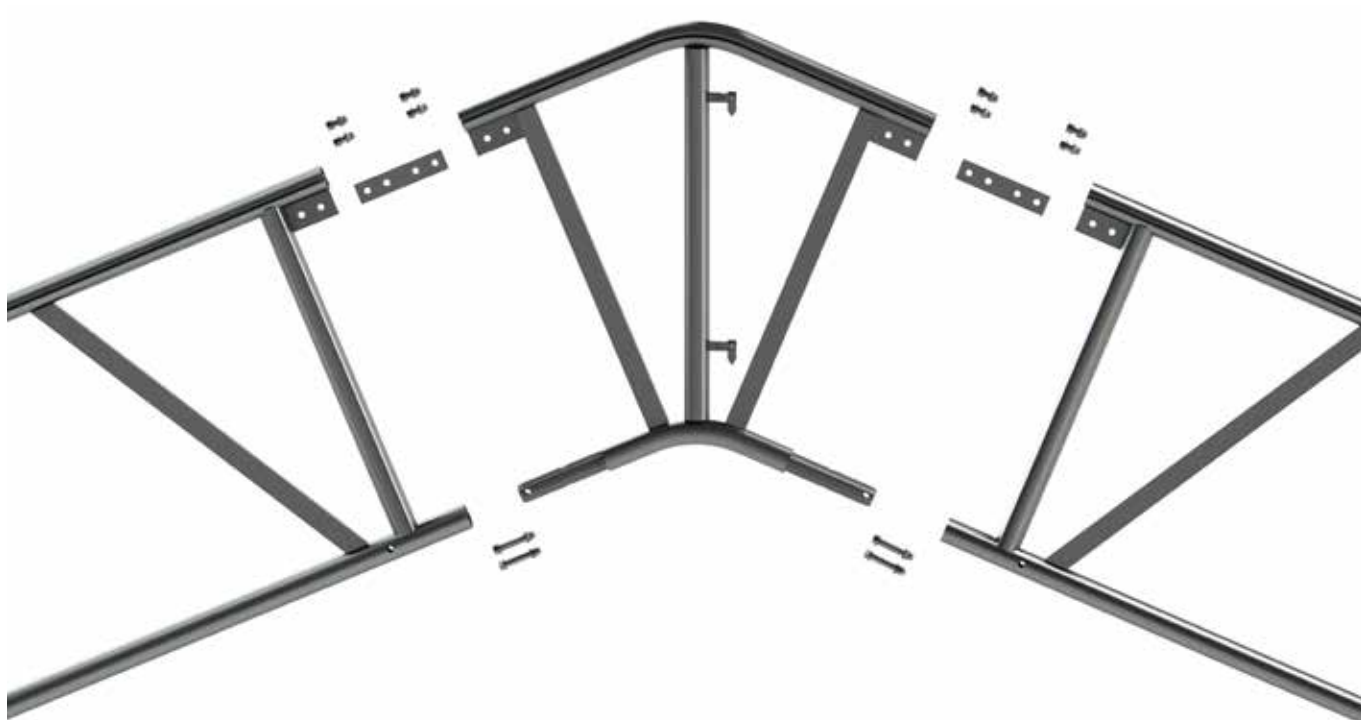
/49. Ułożenie elementów przęsła dachowego.
